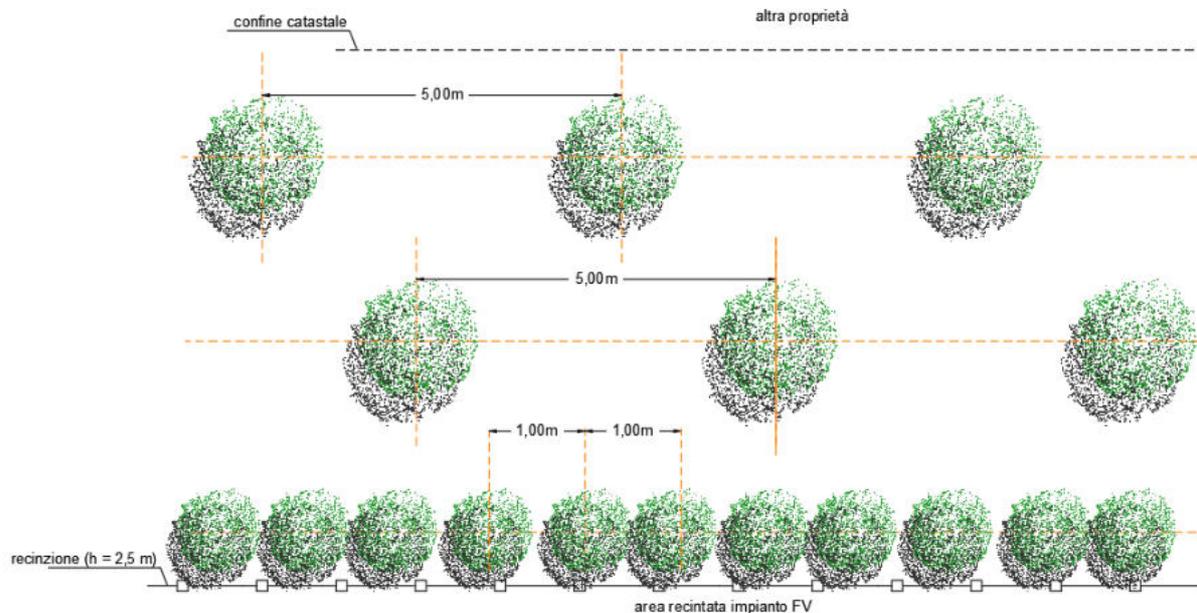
Siepe polispecifica (planimetria di progetto).
